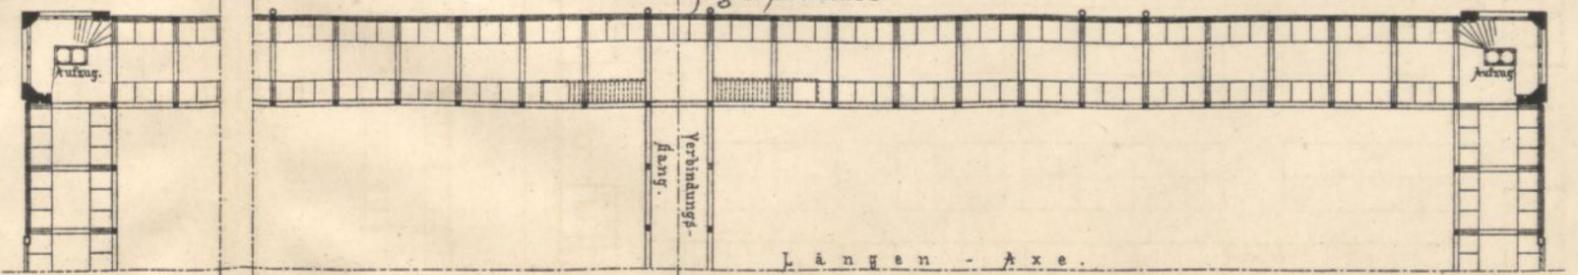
Detail-Markthalle zu Wien. Architekt Haussmann.
